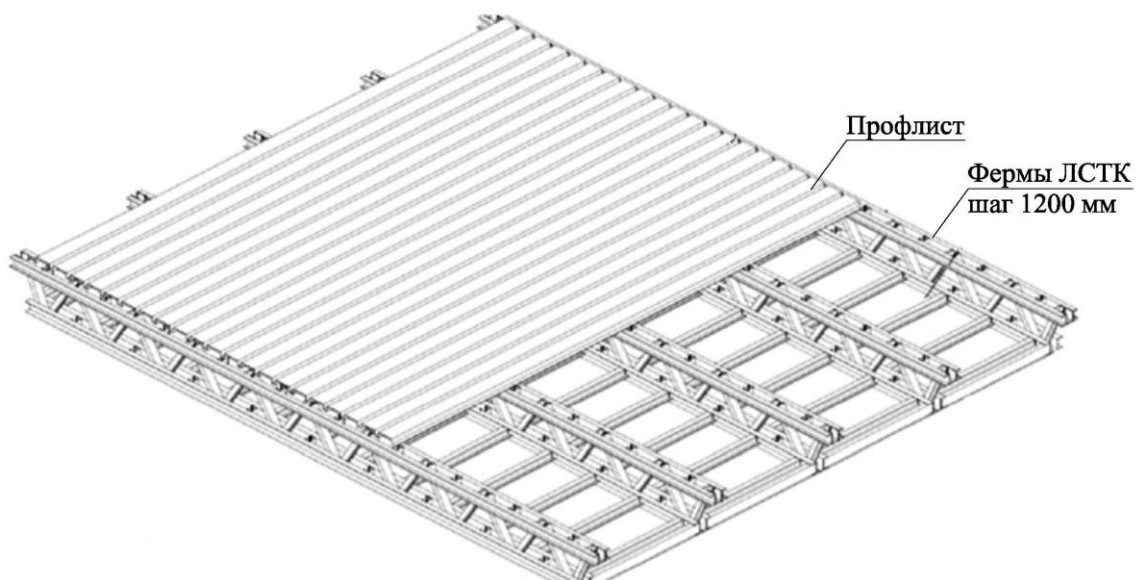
Перекрытие по прогонам из балочных ферм
